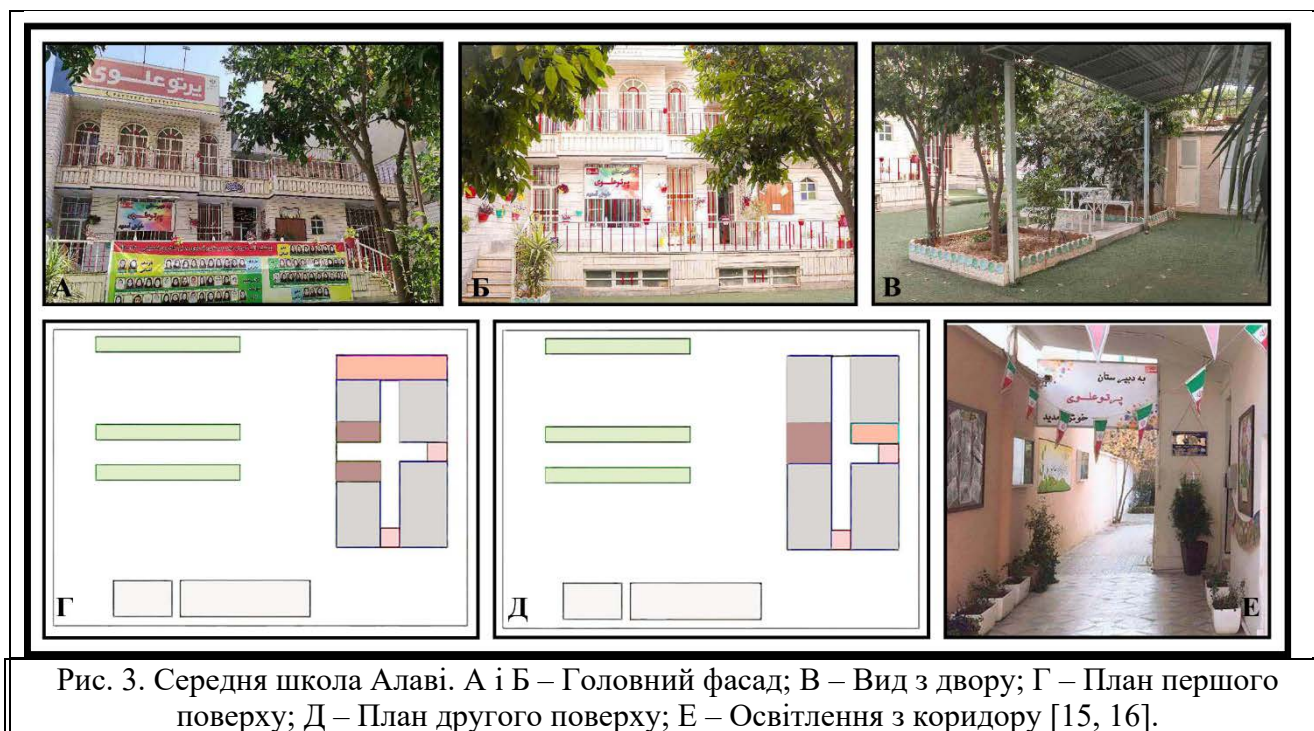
Середня школа Алаві. А і Б – Головний фасад; В – Вид з двору; Г – План першого поверху; Д – План другого поверху; Е – Освітлення з коридору [15, 16].
